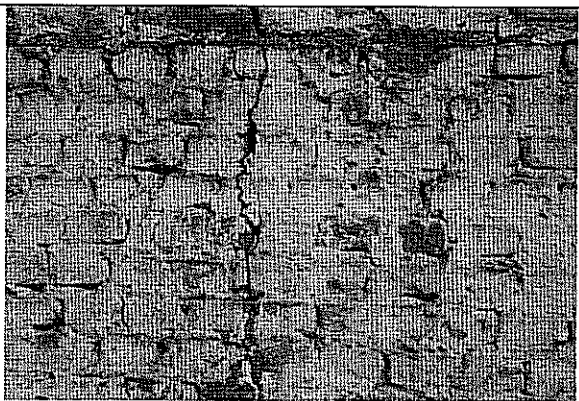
Grieta vertical en el muro del costado sur.
